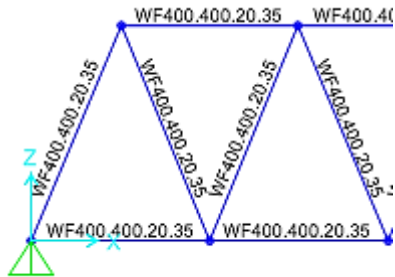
Gelagar melintang atas & ikatan
